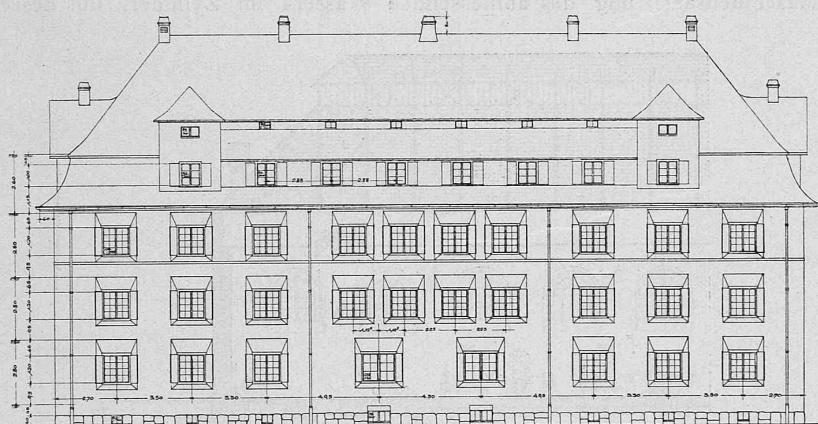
und 4. Bahnseitige Fassade und halbe Strassenfassade. 1:300. — Erbaut 1914 durch das Hochbaubureau der Rh. B., Arch. M. Lorenz.
